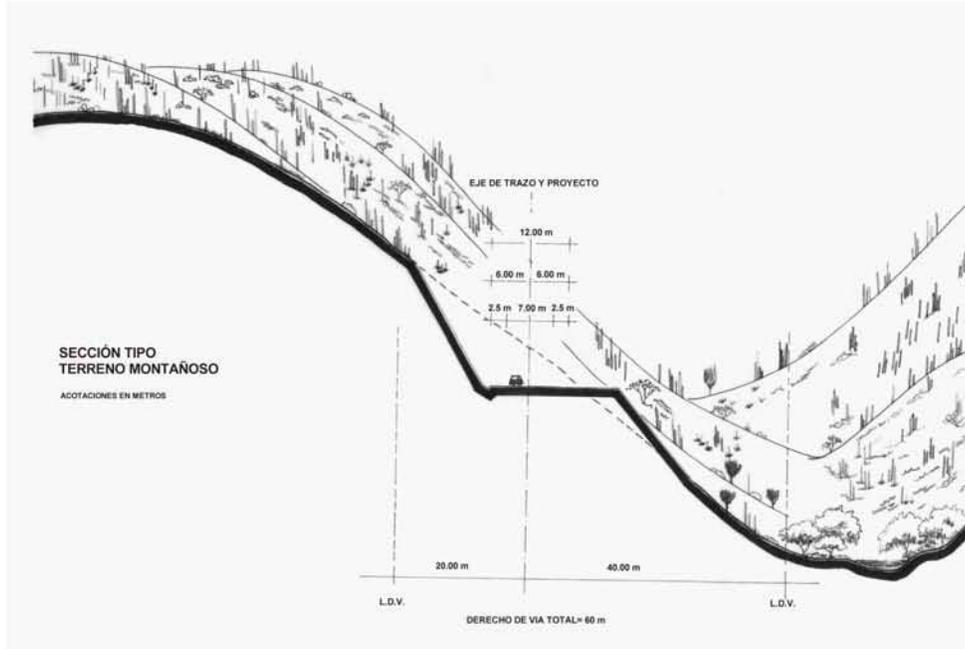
Sección tipo de la Autopista Cuacnopalan –Tehuacan – Oaxaca, zona montañosa.
